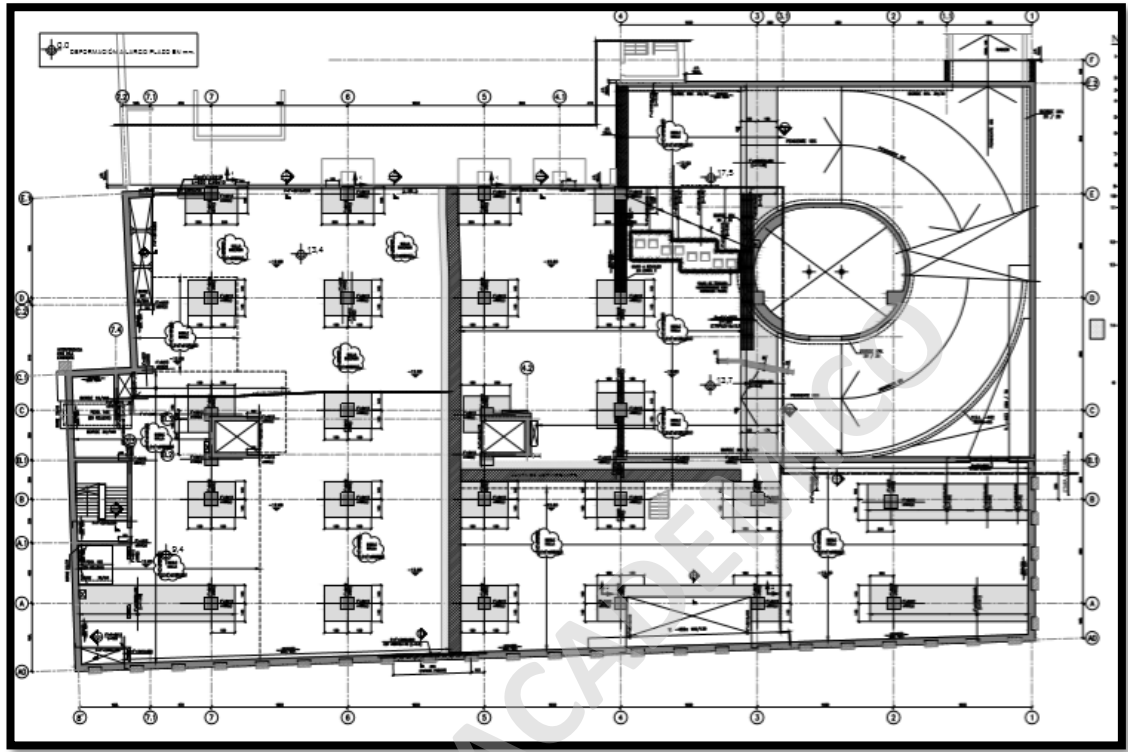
, Plano de refuerzos planta cielo -4 subterráneo, Fuente: ATCacero
